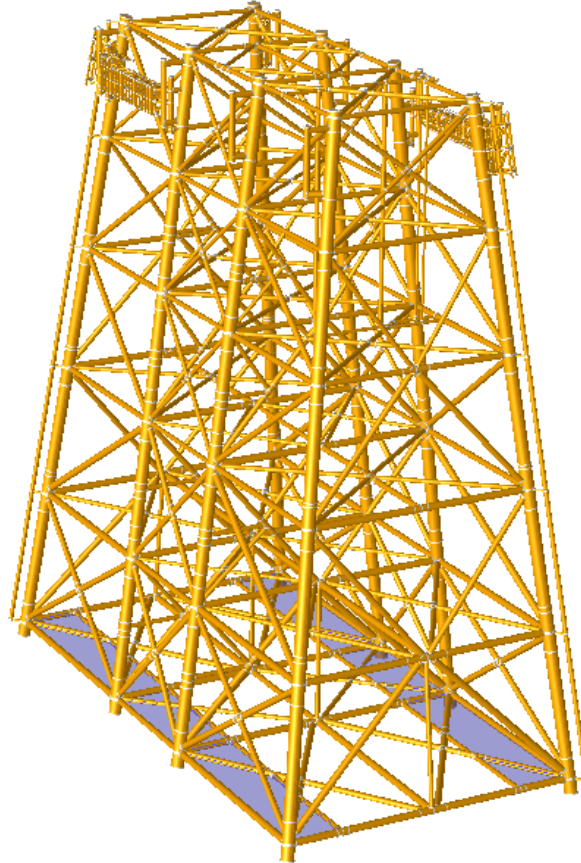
Octápodo ó subestructura de 8 piernas (isométrico).
